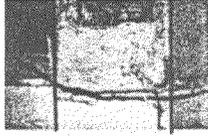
Vista lateral de grieta abajo de la unión columna-ménsula.
